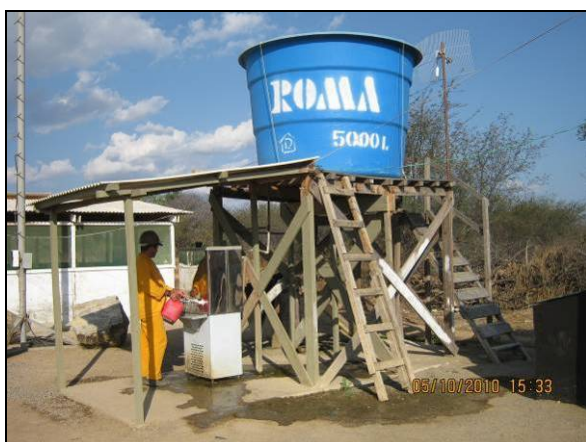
Bebedouro com água potável em ponto de apoio no WBS 2224 (out/10).
